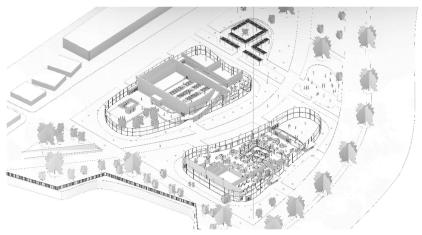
Axonométrica proyecto sin cubierta. Fuente: Elaboración Propia.
